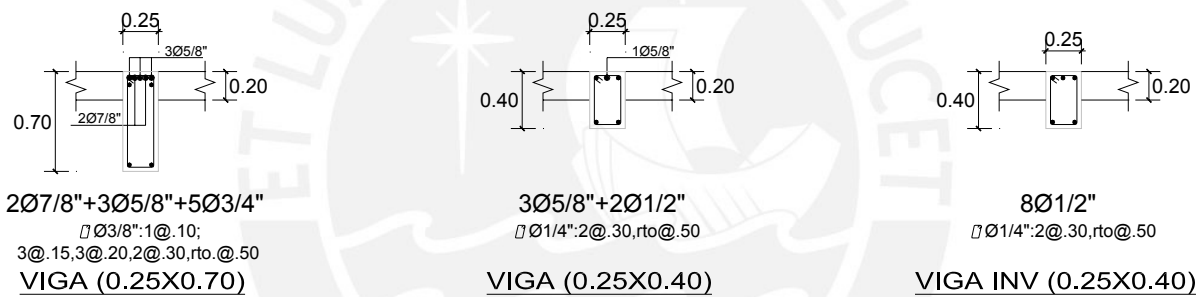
Detalle de vigas de concreto armado (Edificio de educación superior pre NDSR-1997)
